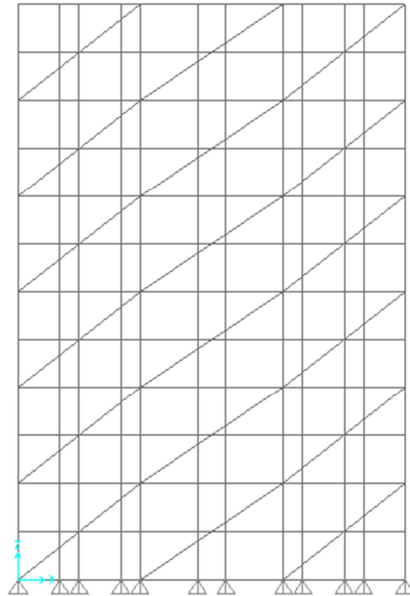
Configuração dos Planos de Contraventamento Vertical Com Elementos de Contraventamento Grandes
